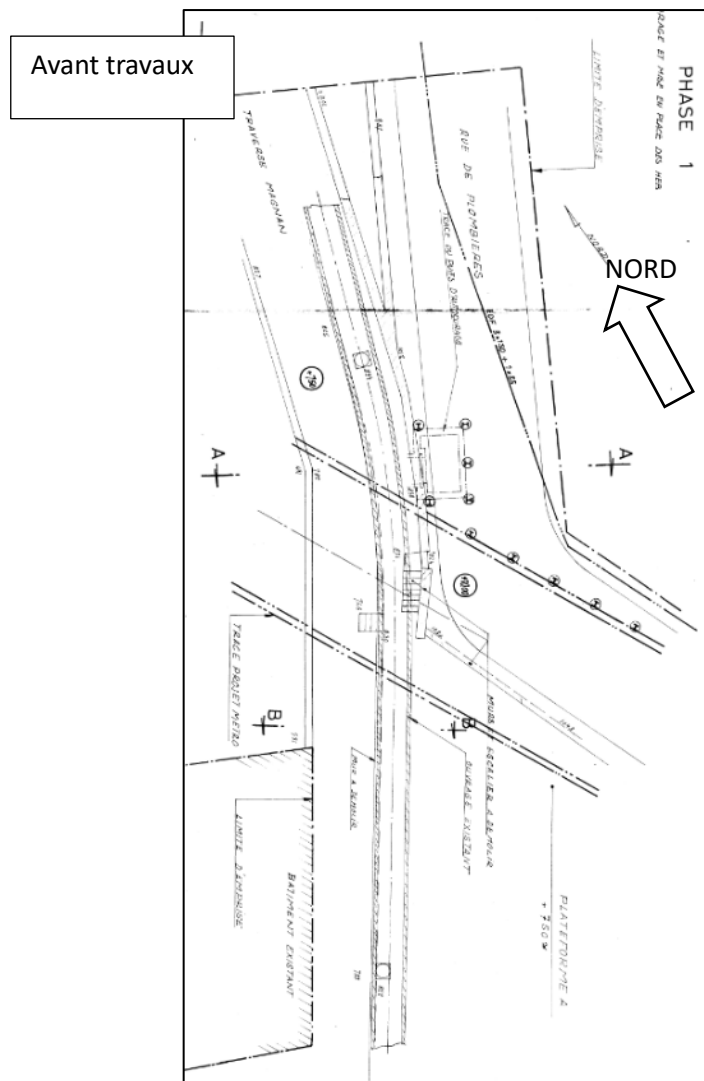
Extraits plan PHASAGE BEAL MAGNAN plan 15/055^B – Dossier OUVrage RTM
